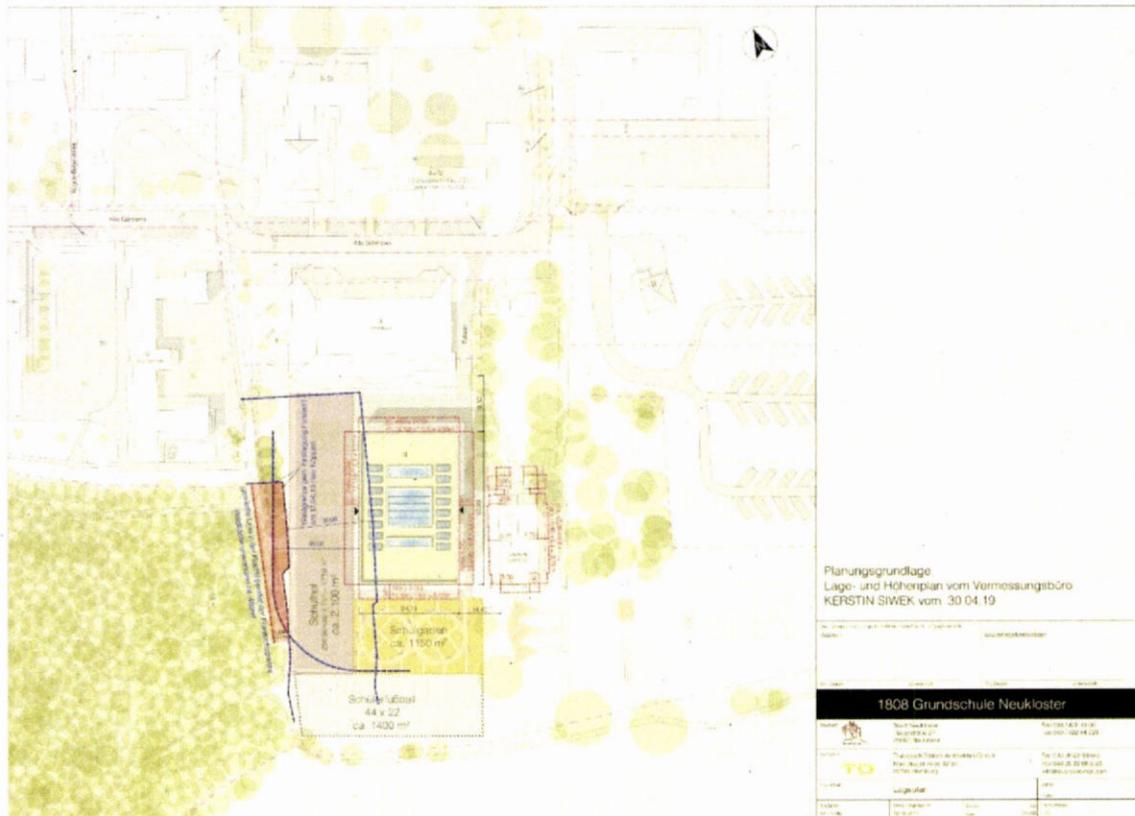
Lageplan für den Neubau der Grundschule mit Freiflächengestaltungskonzept und Waldumwandlungsfläche (Trabitzsch Dittrich Architekten GmbH, Hamburg, 20.05.2019) als Grundlage für den Bebauungsplan
